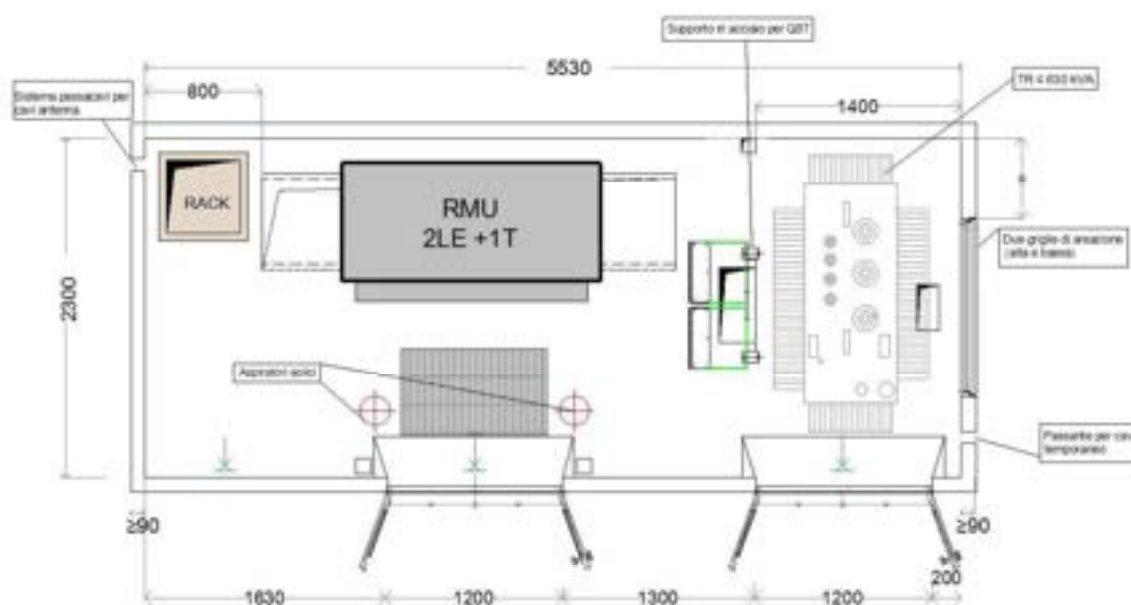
Pianta dimensionale e funzionale Standard Box (esempio installazione RMU 2LE+1T) –
